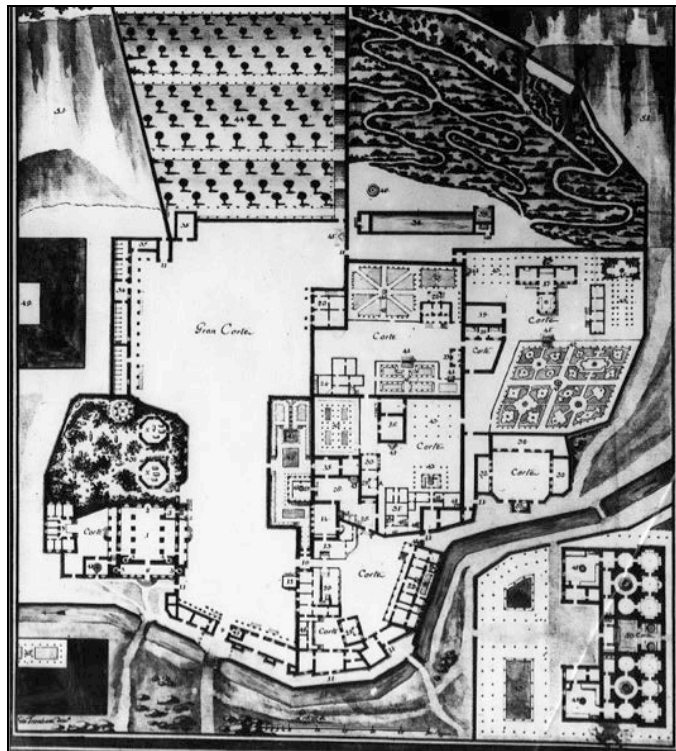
Hansaray' in Planı, 1787 (G. Trombaro)
